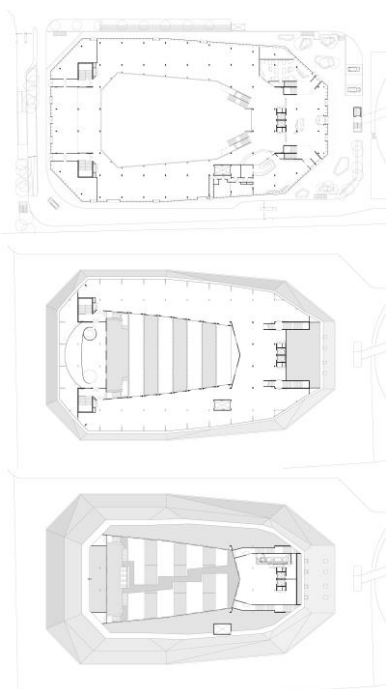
Grundrisse EG, 2. OG, DA
